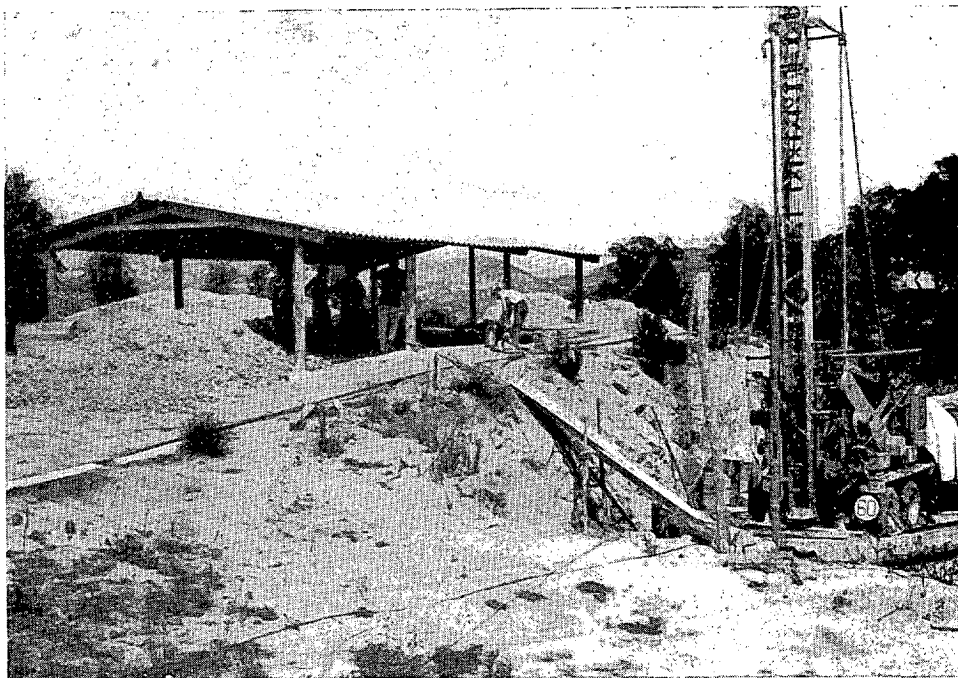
Conjunto de la instalación de preparación y puesta en obra de la arcilla.
